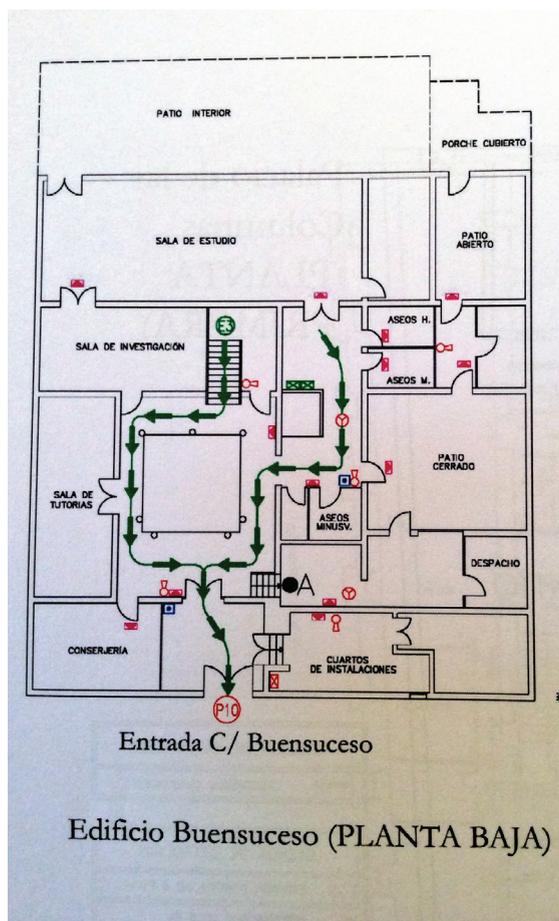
Plano de la planta baja de la FTI de la UGR.
